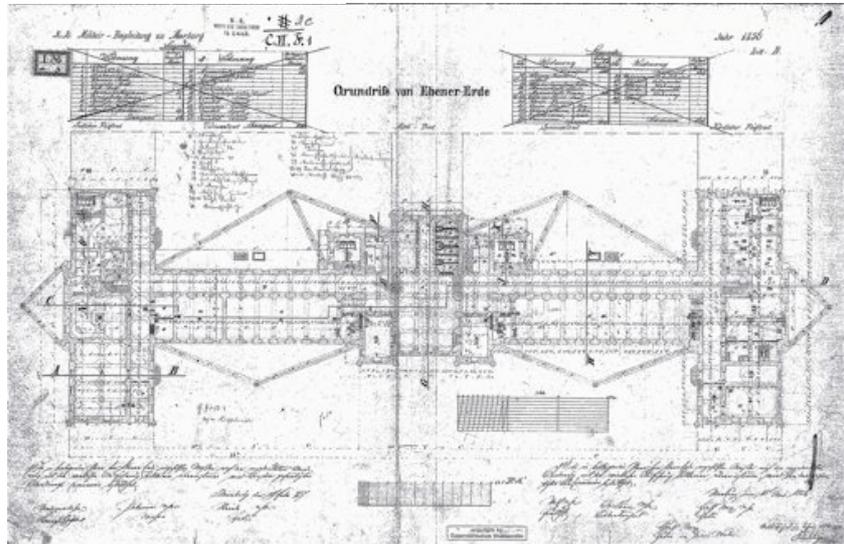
k. k. Kadetteninstitut, Marburg, Grundriss, Erdgeschoss, 1856
